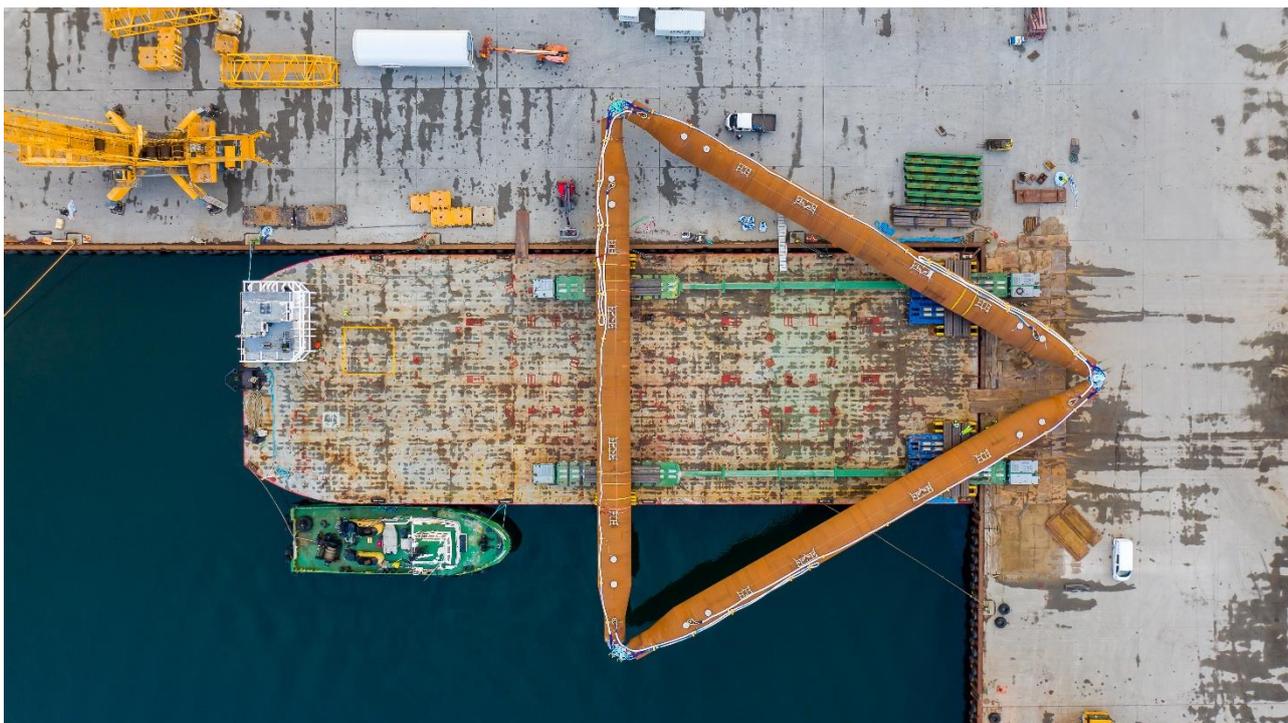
Assemblaggio della fondazione galleggiante *TetraSpar* presso il porto di Grenaa, Danimarca
